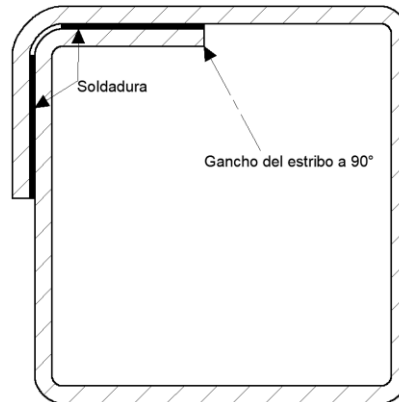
Detalle de estribo cerrado con soldadura
